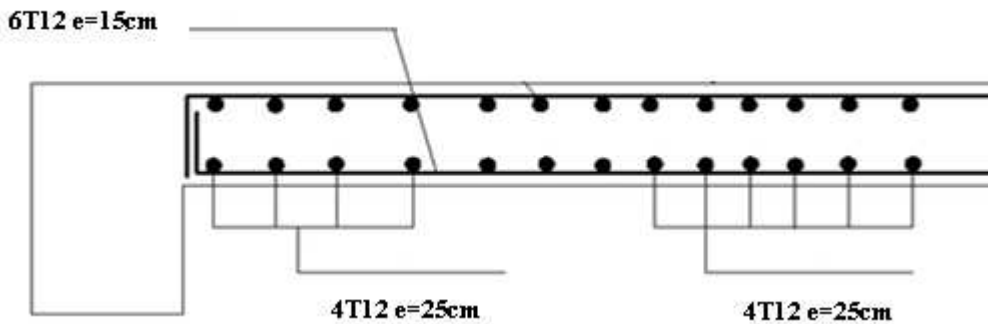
Schéma de ferrailage da la dalle pleine
